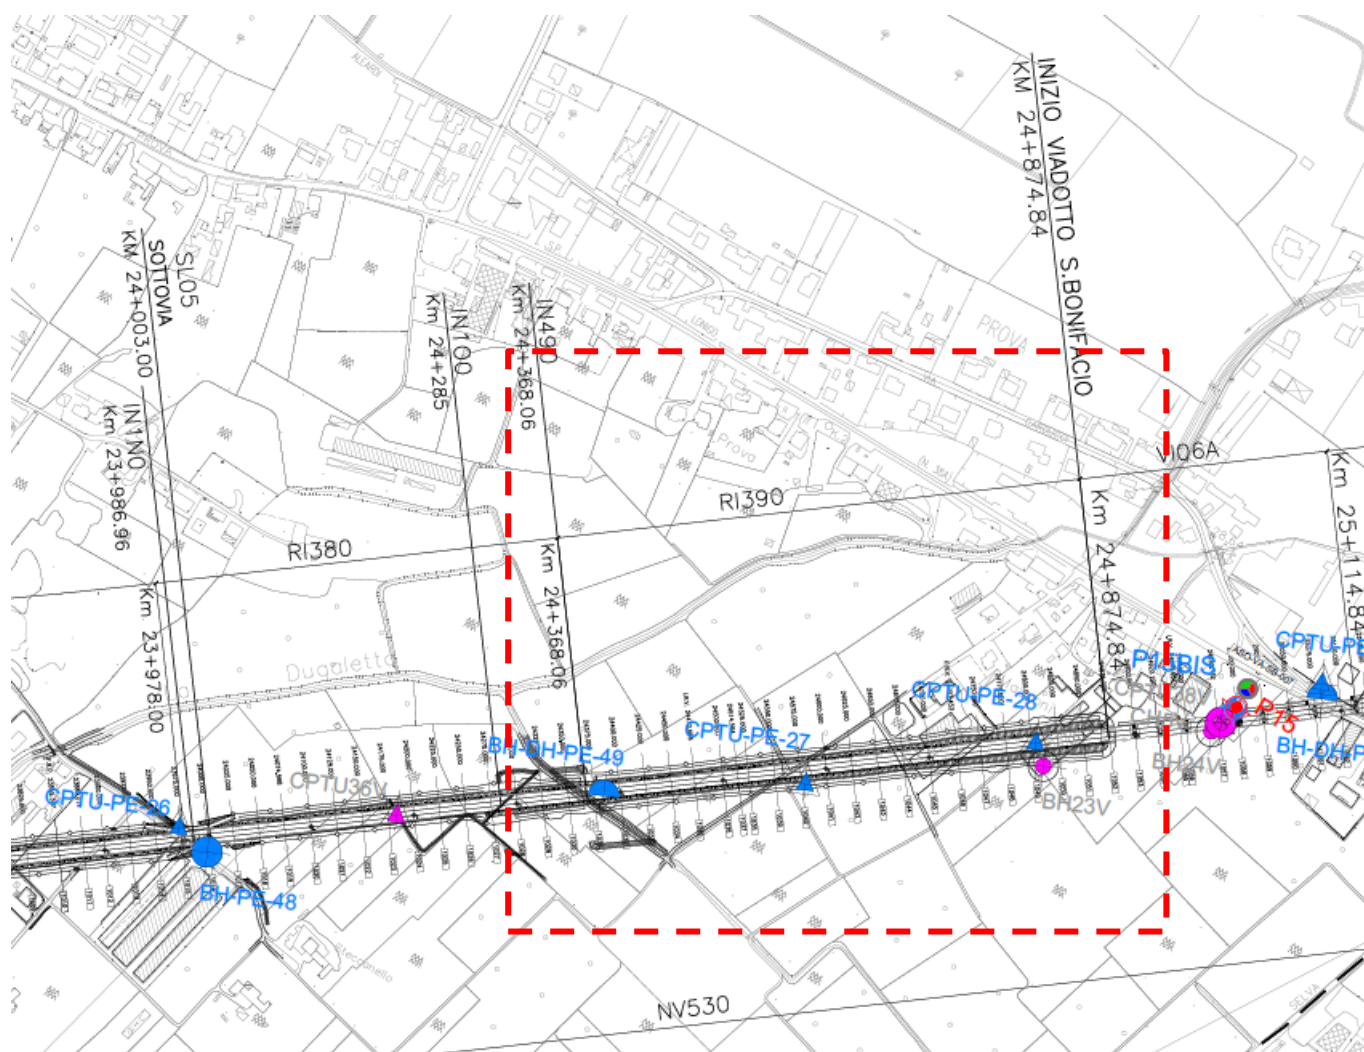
Planimetria Rilevato RI39, estratto dalla Planimetria Generale (Doc. Rif[3])
